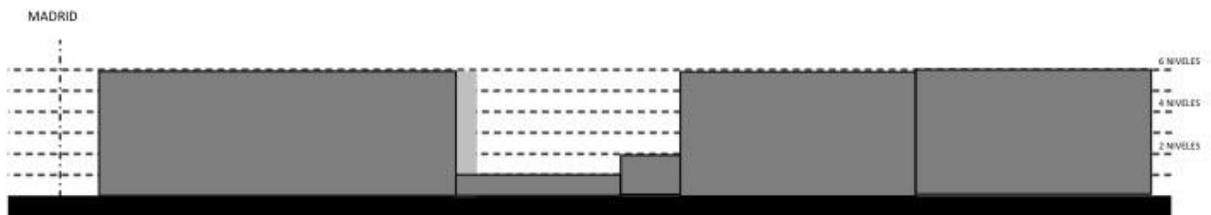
Perfil urbano que muestra las alturas sobre Insurgentes en dirección sur-norte antes de la calle Sullivan.
